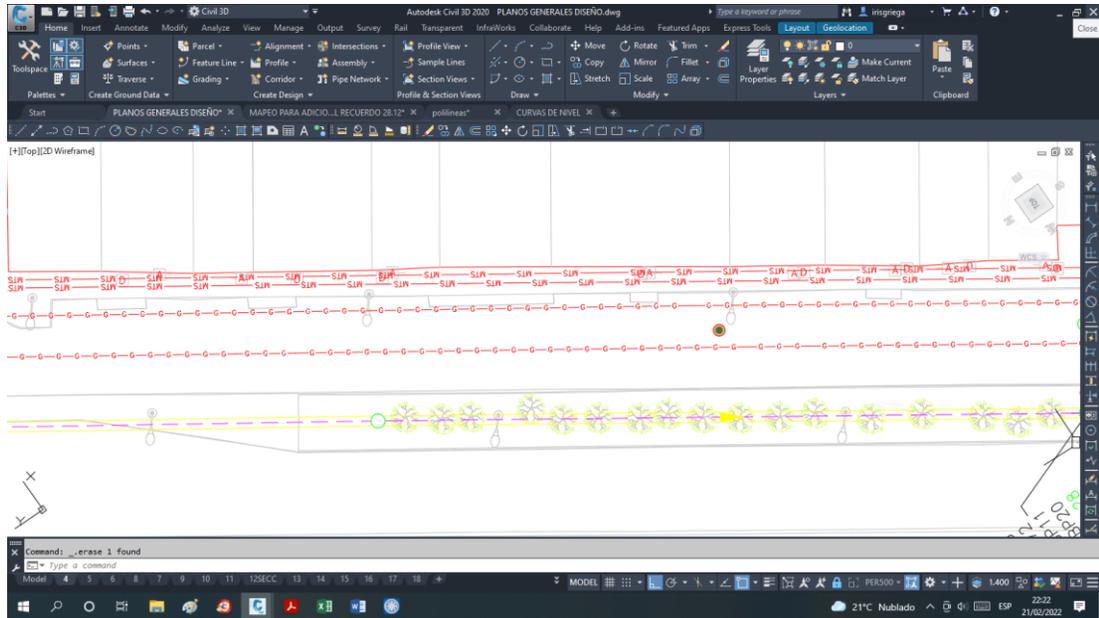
Vista Parcial Del Plano De Interferencias.
